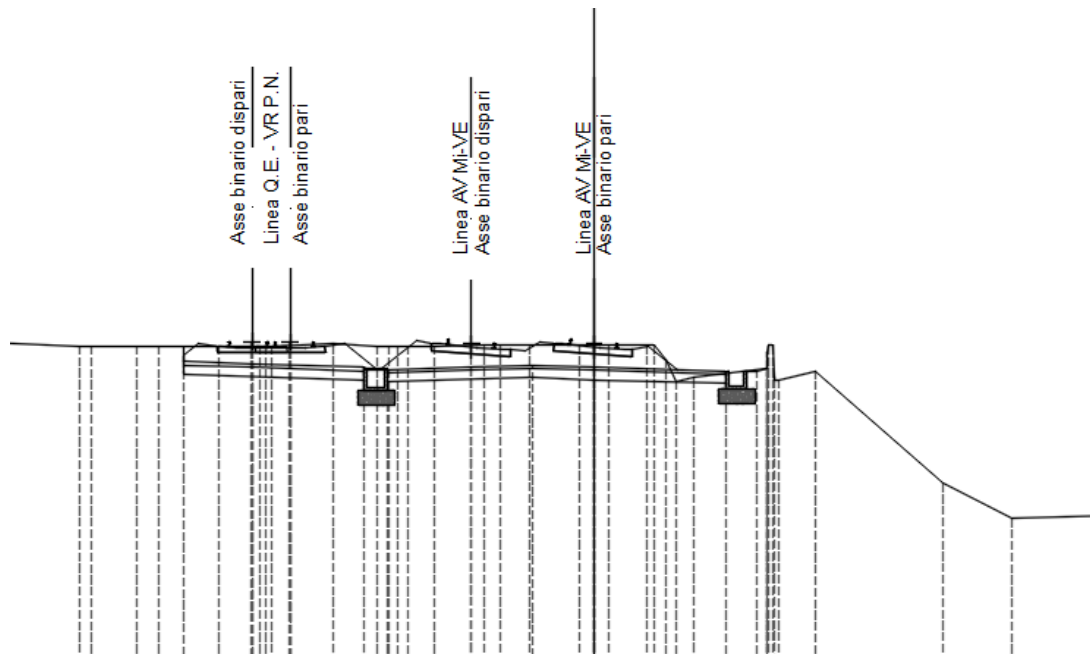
Planimetria dell'intervento del sottovia ferroviario, situato in corrispondenza del km 147+885
